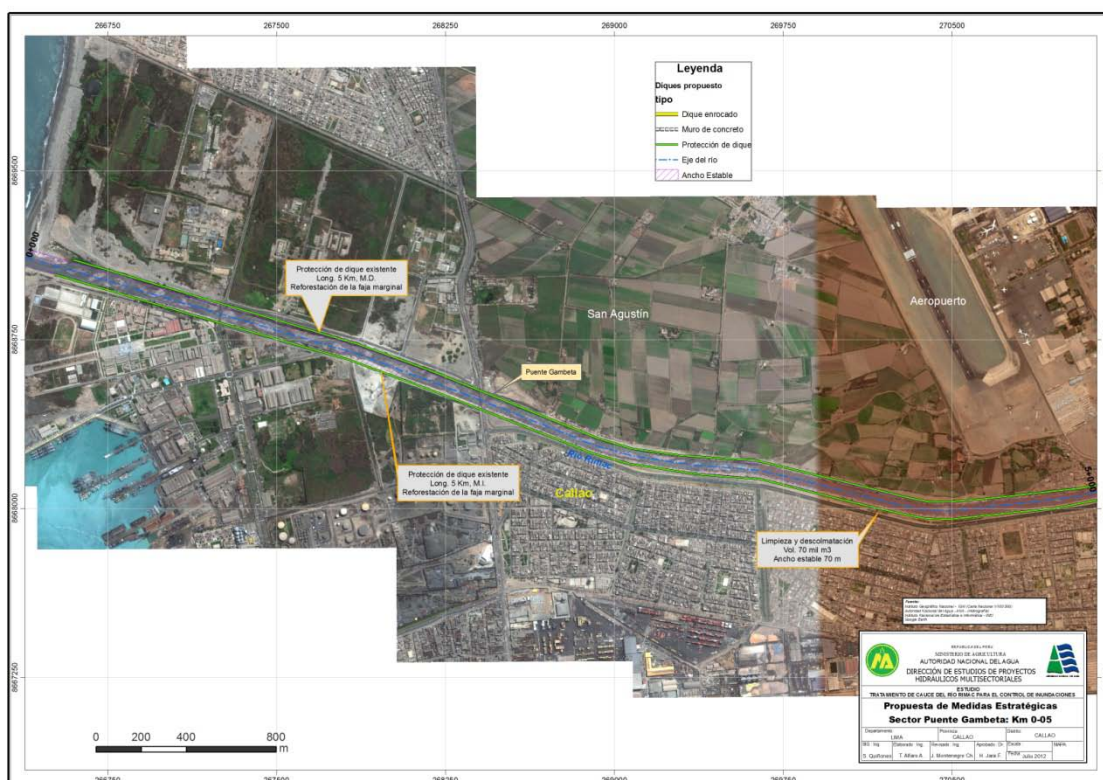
Propuesta de medidas de prevención, sector Puente Gambeta
